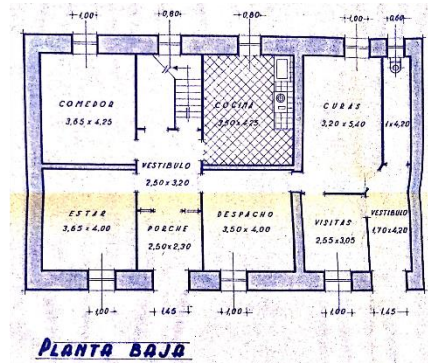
Planta del proyecto de Centro rural de higiene Fuente: Archivo Ibeas de Juarros
